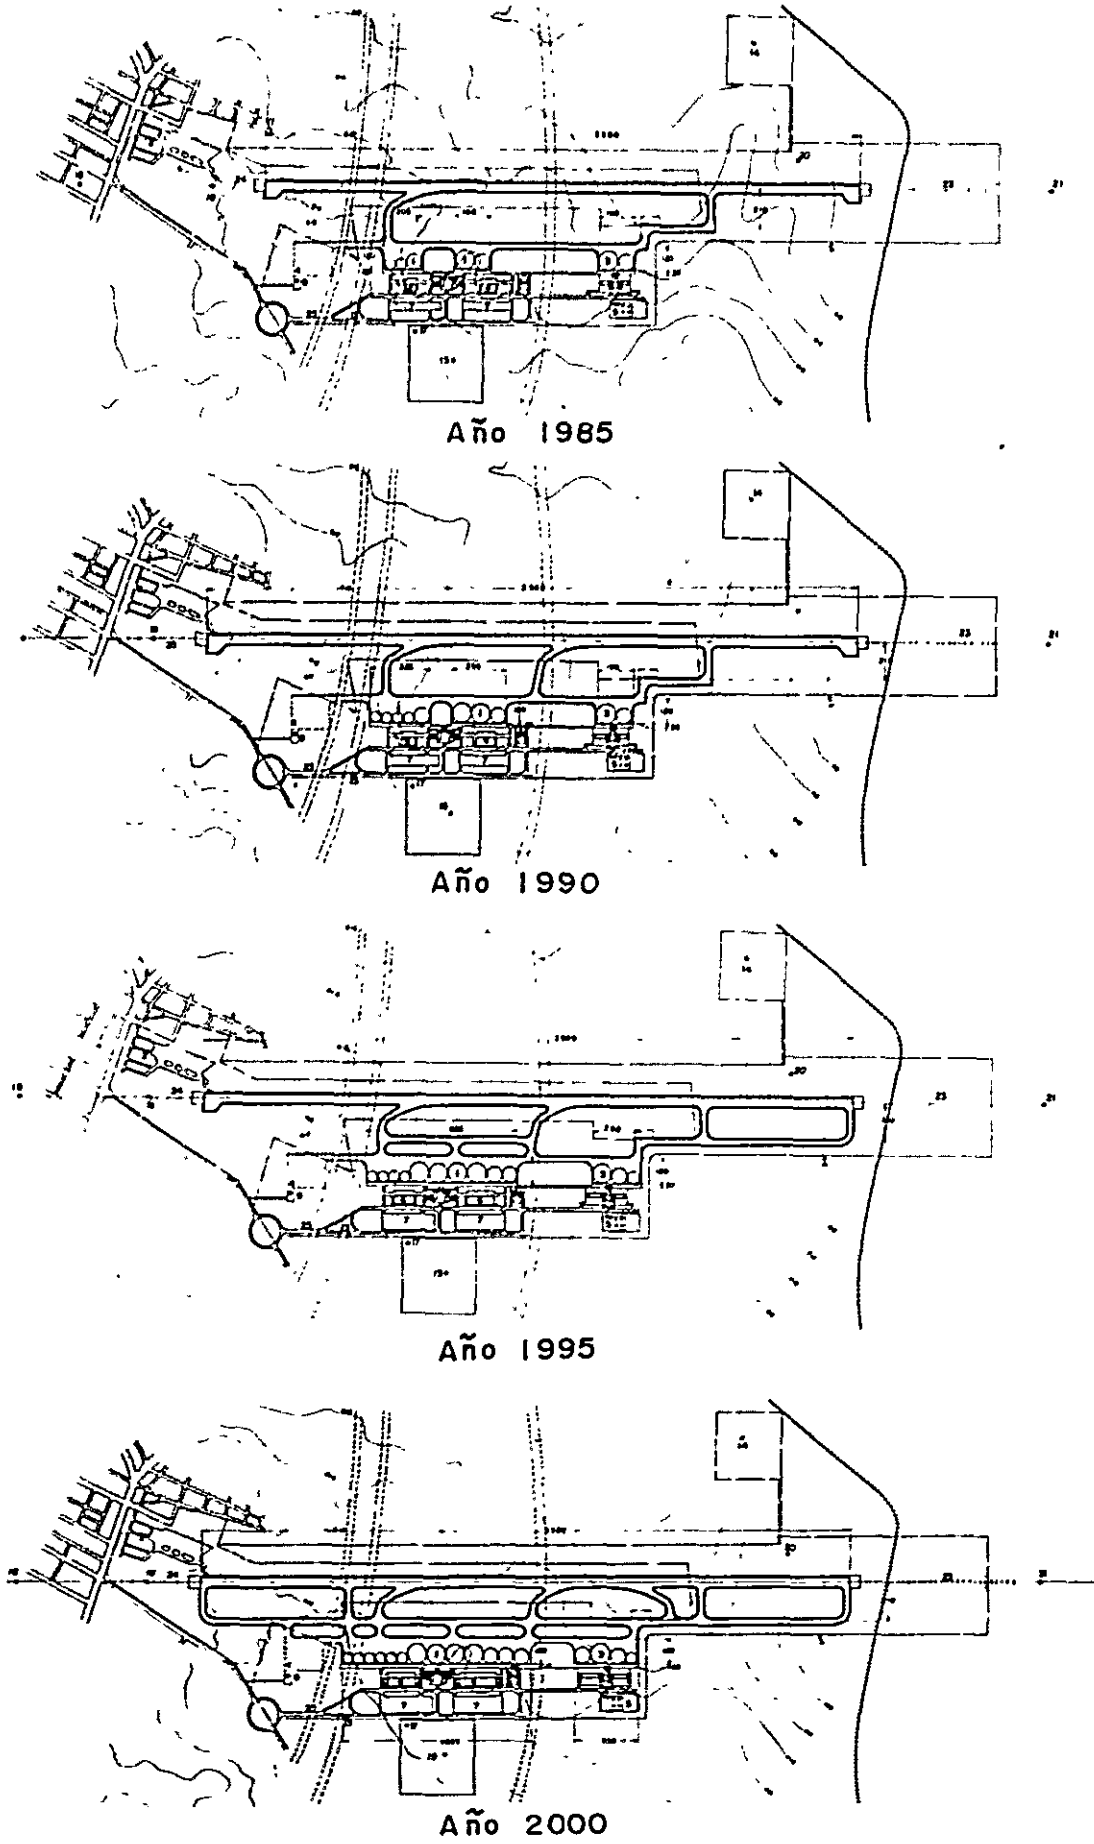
Plan de Expansión del Aeropuerto Actual
